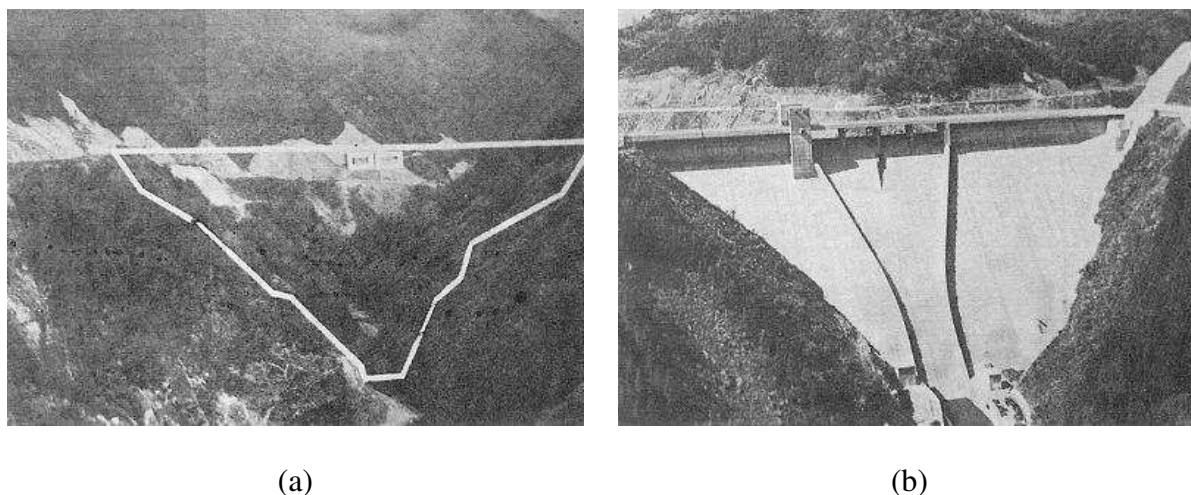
Barragem em CCR - SHIMAJIGAWA: (a) Vista do local de construção da barragem; (b) Vista da barragem concluída (ANDRIOLO, 1993)
